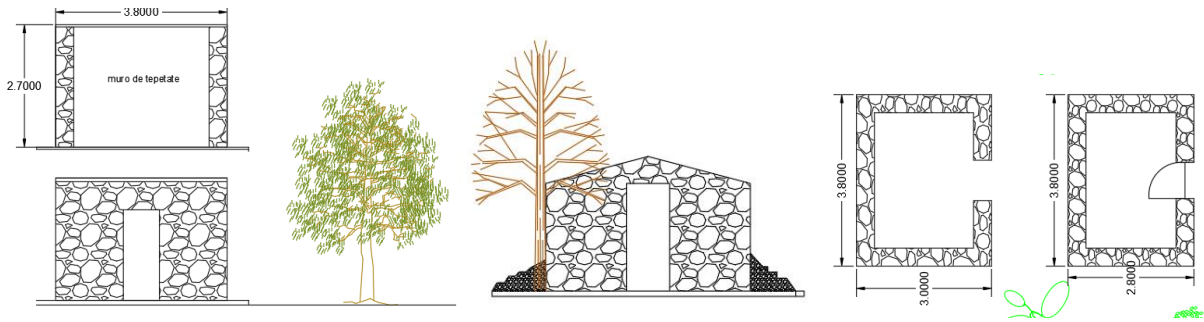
Capilla de mampostería, planta, corte, alzado (autoría propia )
